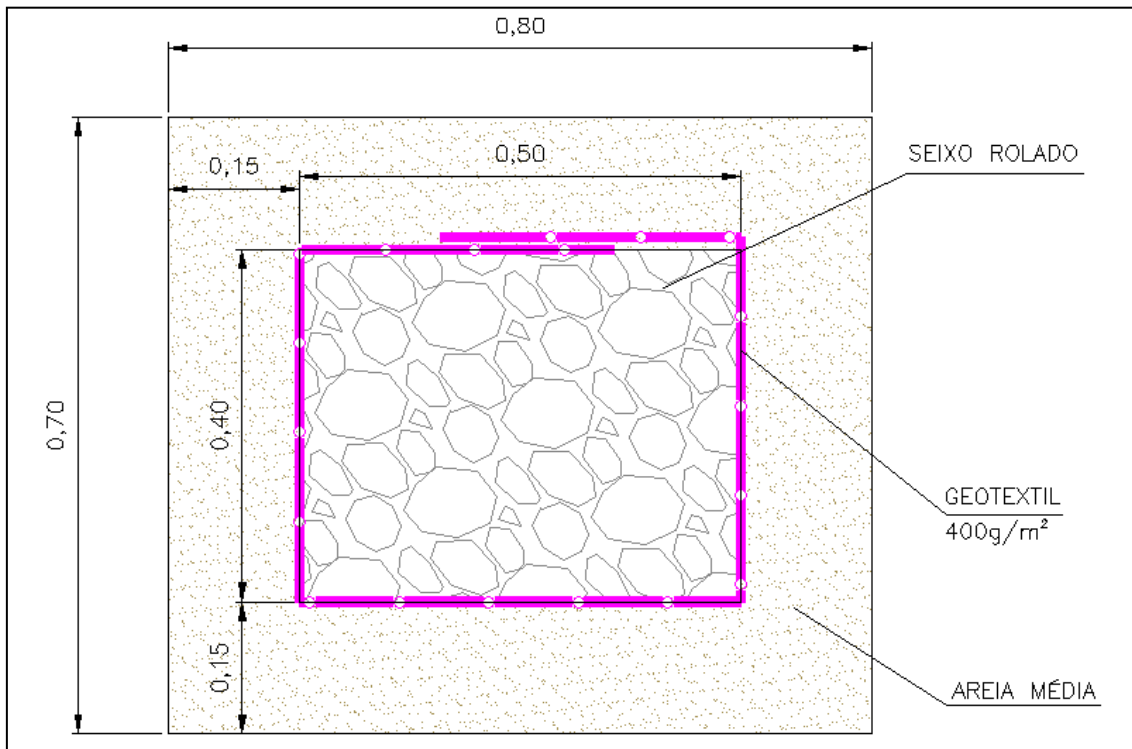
Detalhe Típico – Drenos (D1-3541-54-G-163)
